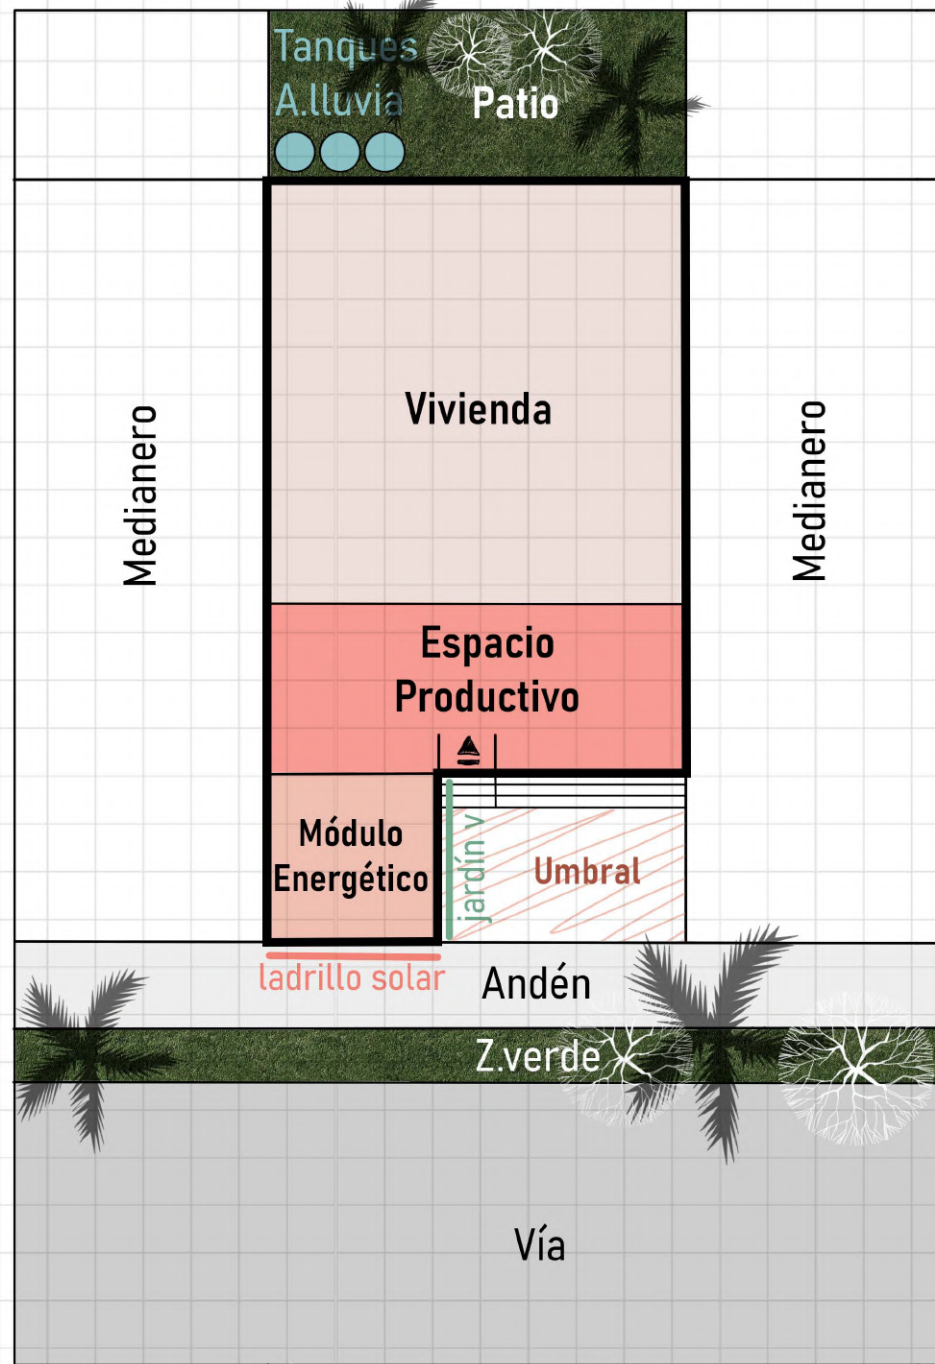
Planta esquemática de la propuesta para la vivienda sobre la vía principal pavim. Elaboración propia.
